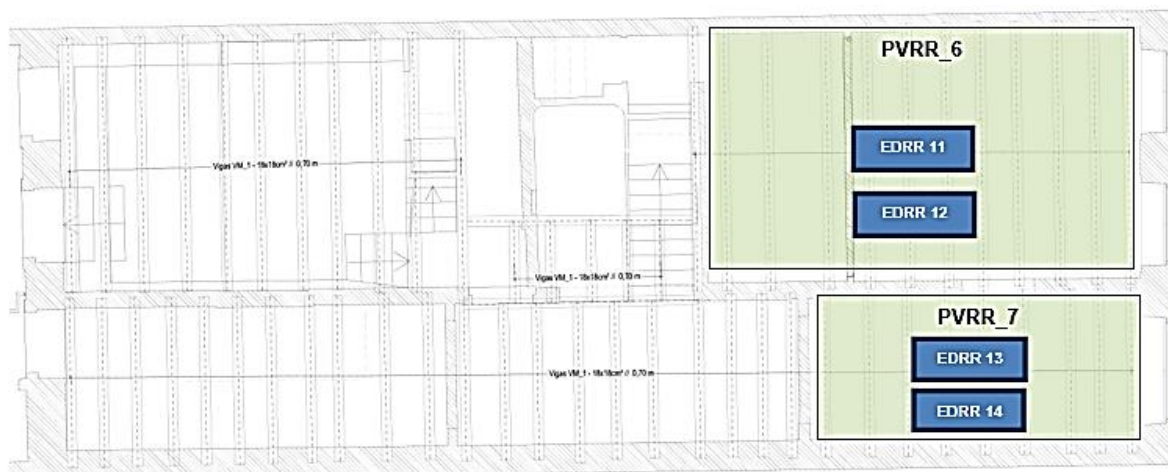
Planta do piso 1, com a identificação esquemática dos pavimentos e ensaios dinâmicos
